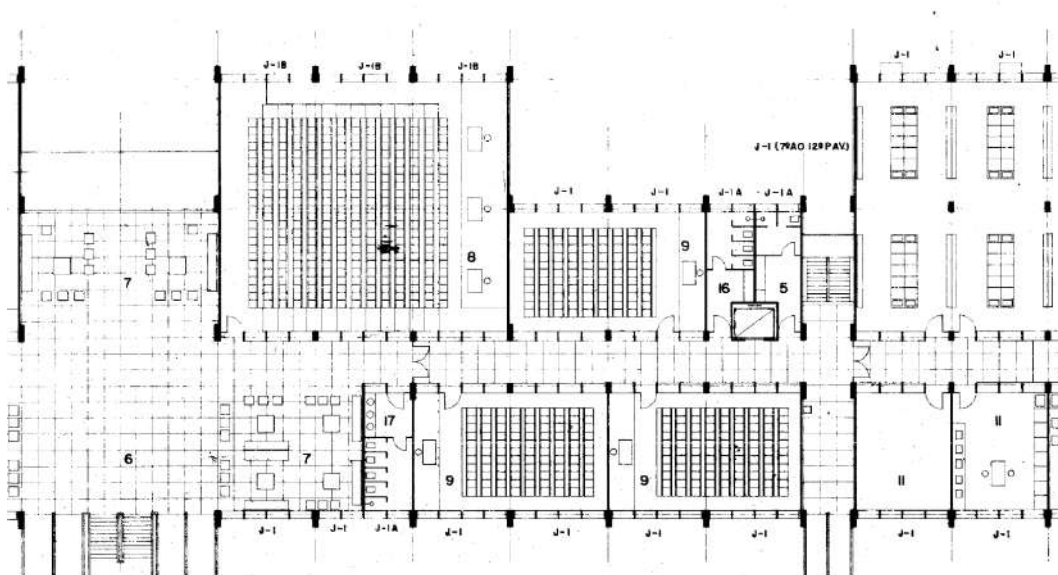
UERJ. Conjunto Escolar, pavimentos tipo nº 2, 4, 6, 8, 10, 12. Anteprojeto. Ampliação de trecho do pavimento.
